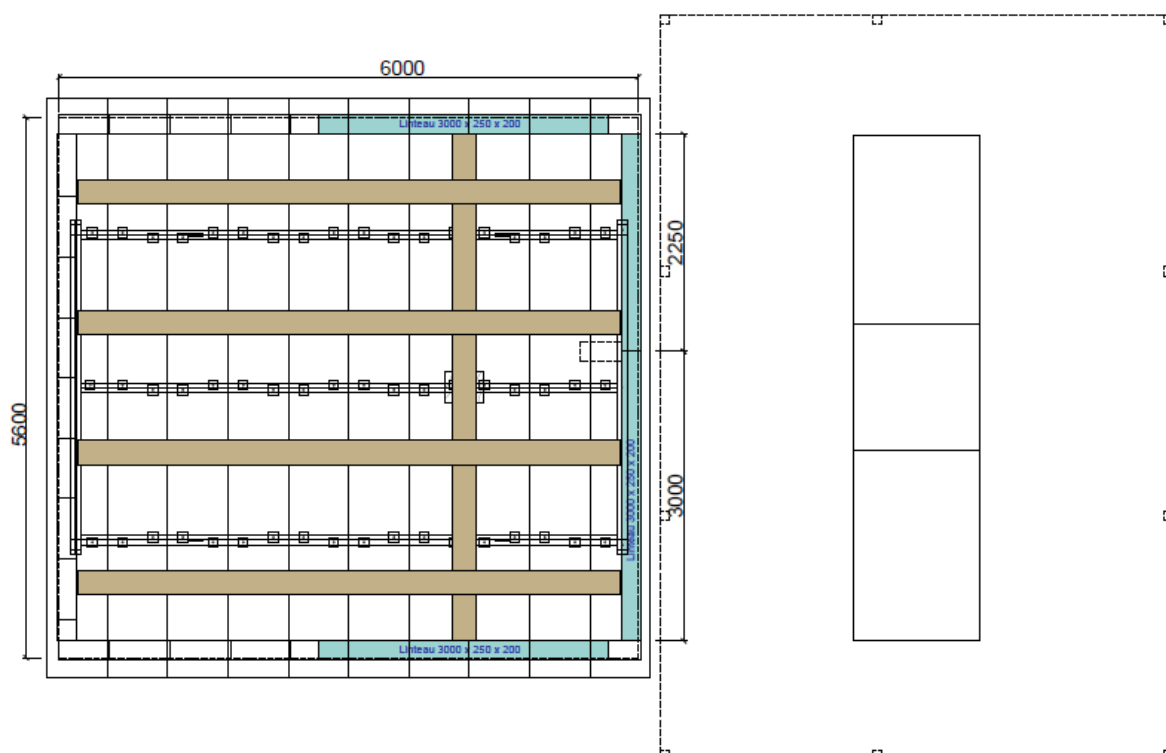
Vue de dessus de la cellule d'essai pour l'essai 3 (poteau/poutres LC)
